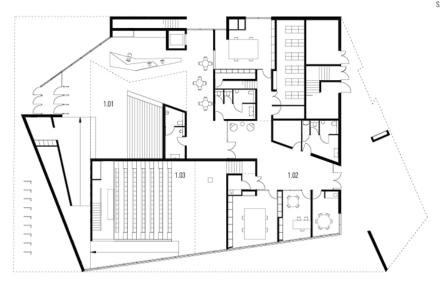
Planta arquitectónica baja, Mediateca de Anzin.
